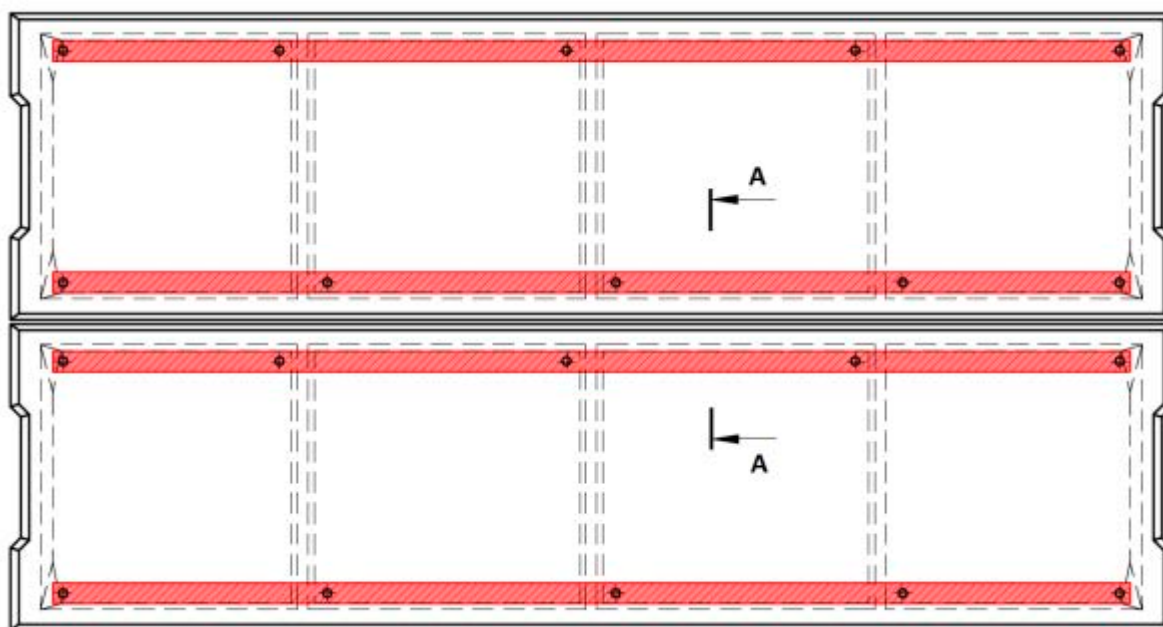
Схема расположения направляющих профилей. Вид сверху
